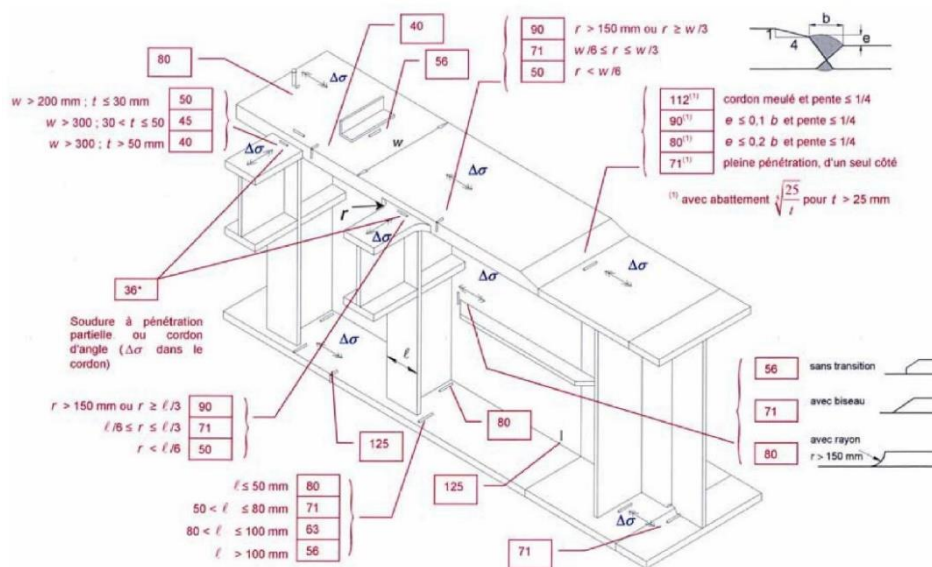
Détails classiques d'un bipoutre mixte (en MPa)
